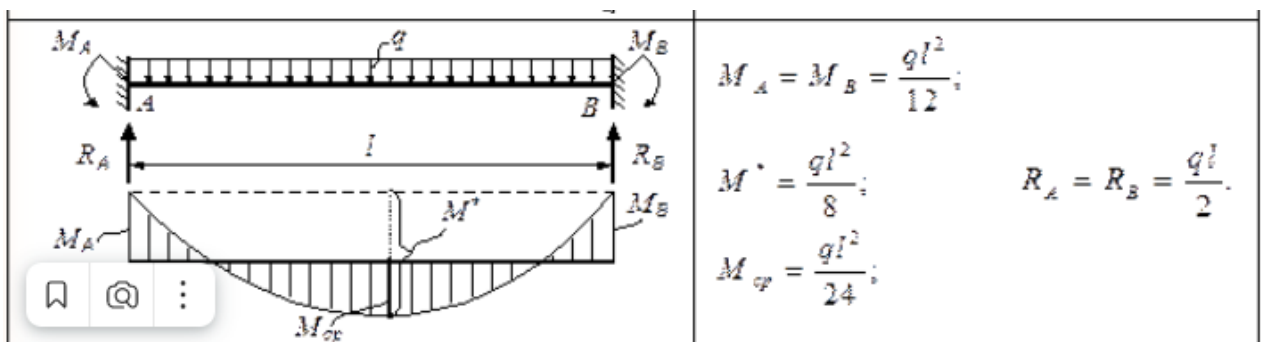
Схема работы конструкции при жёсткой заделке обоих концов (схема работы до демонтажа)
